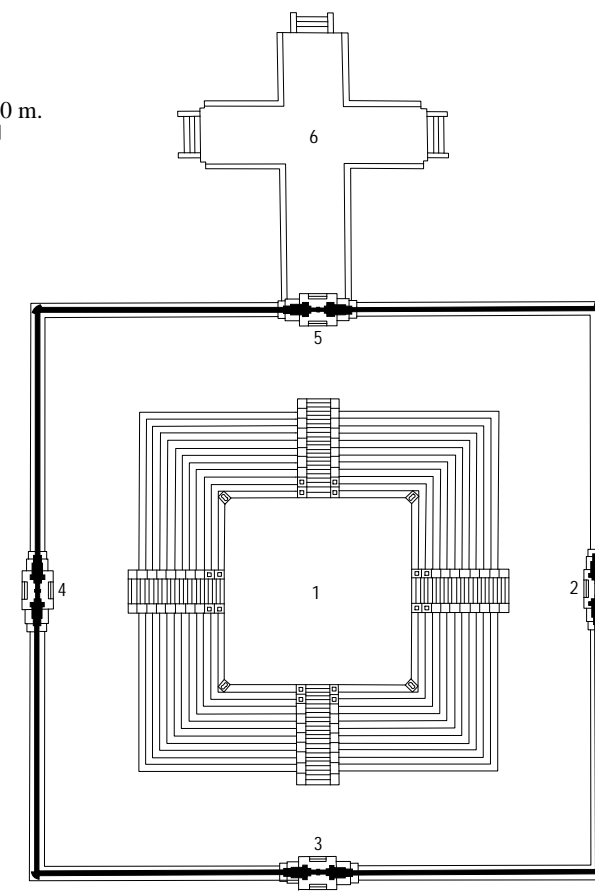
Plan du Prasat Damrei du Preah Khan de Kompong Svay
